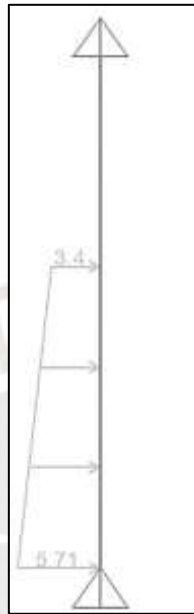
Cargas últimas aplicadas en el muro de sótano (ton/m)
